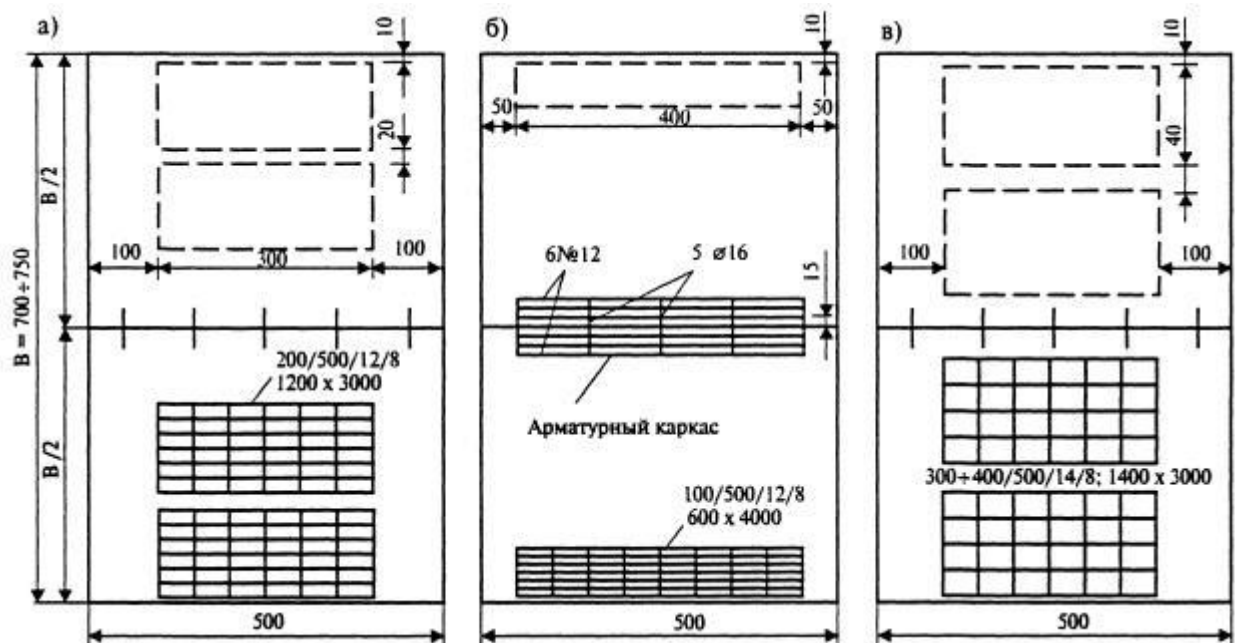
Схеми армування плит цементобетонних покриттів автомобільних шляхів
